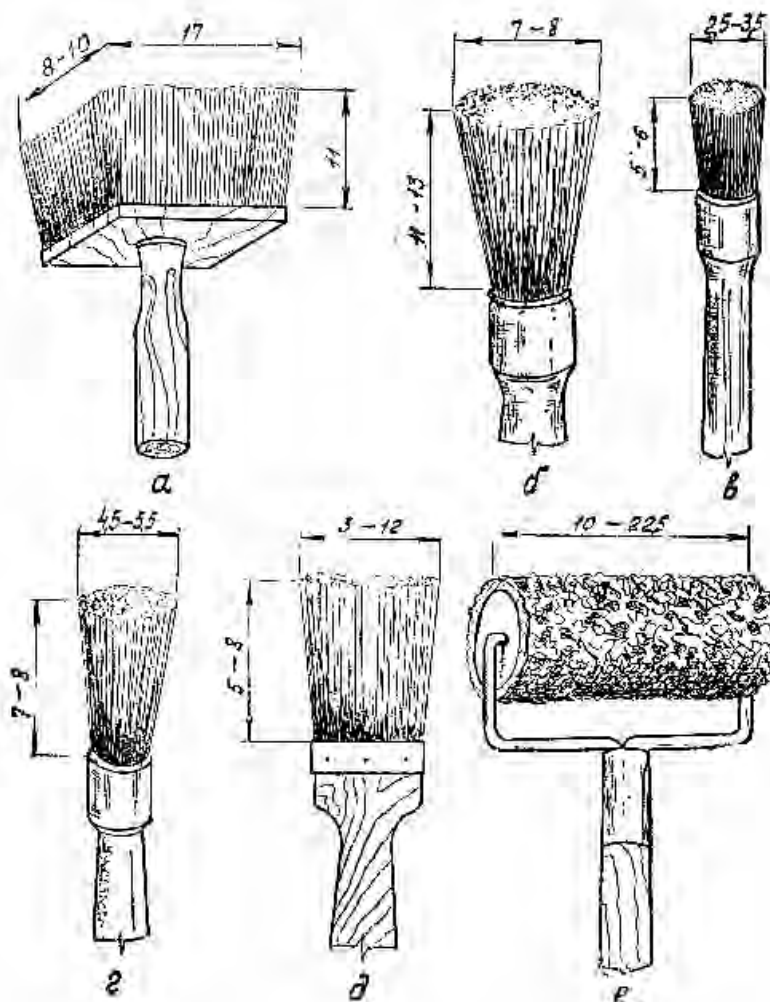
Малярный инструмент для окраски поверхностей вручную:
